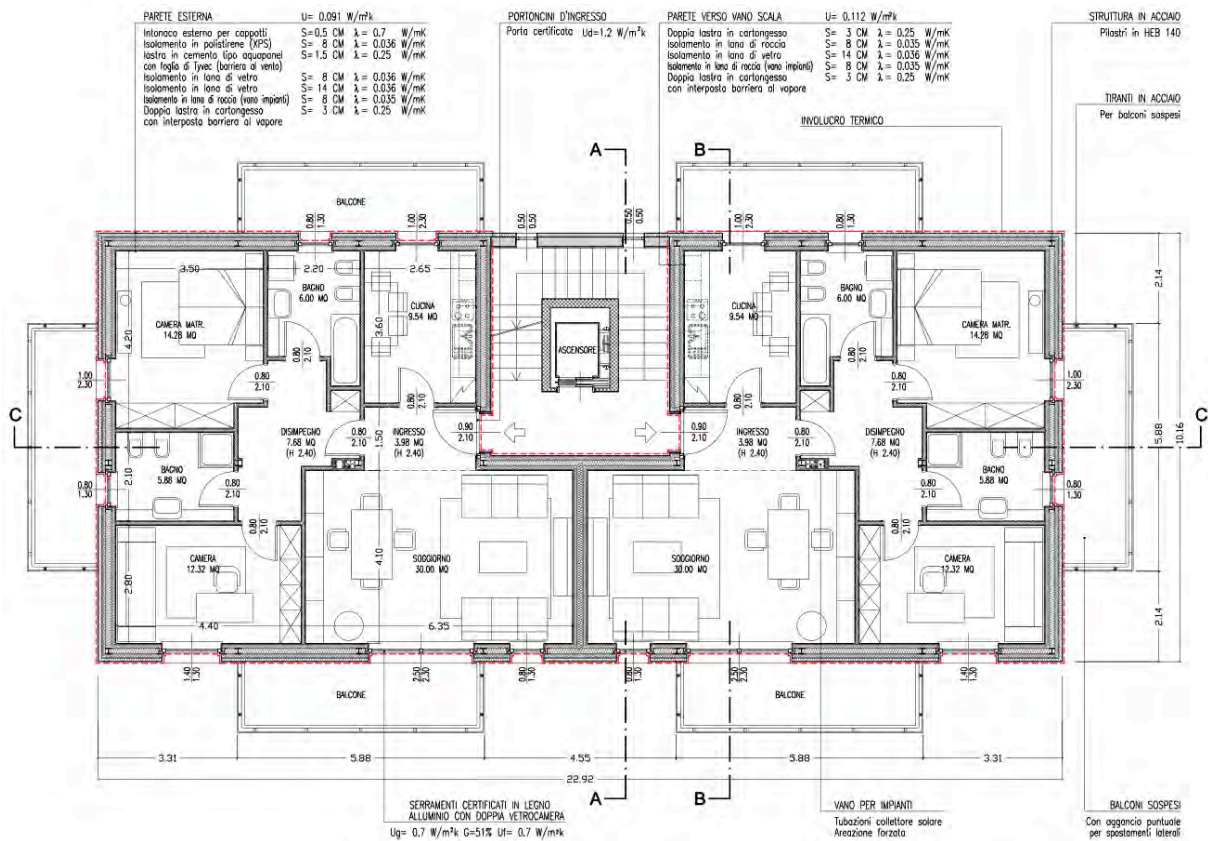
Palazzina: pianta P.1 e P.2 - archivio personale
